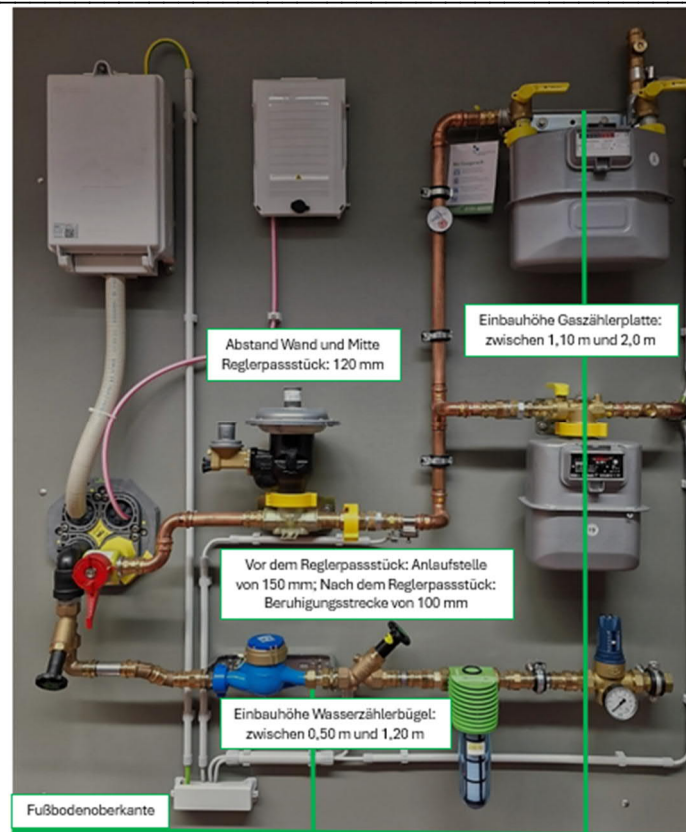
Bemaßung der Bauteile an Hausanschlusswand, eigene Darstellung
